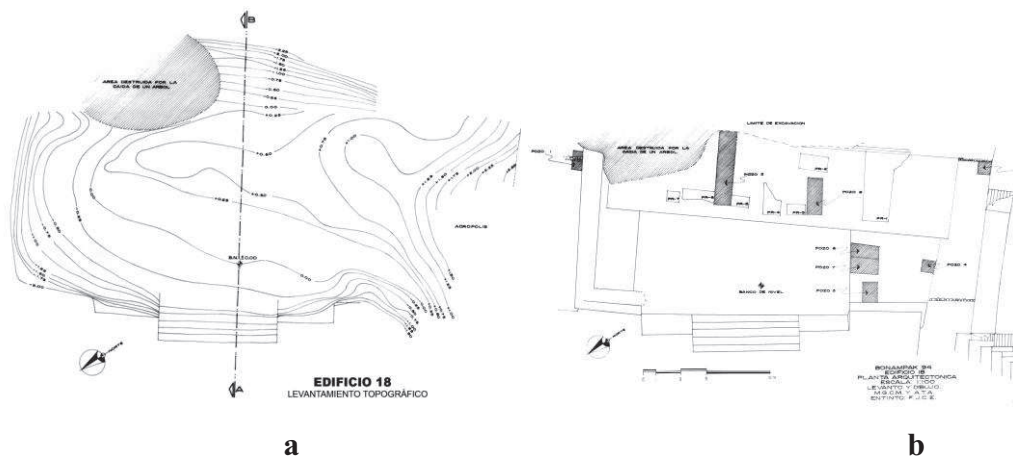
, levantamiento topográfico del edificio 18 previo a su excavación; figura 5.9b, levantamiento arquitectónico al final de la restauración.
